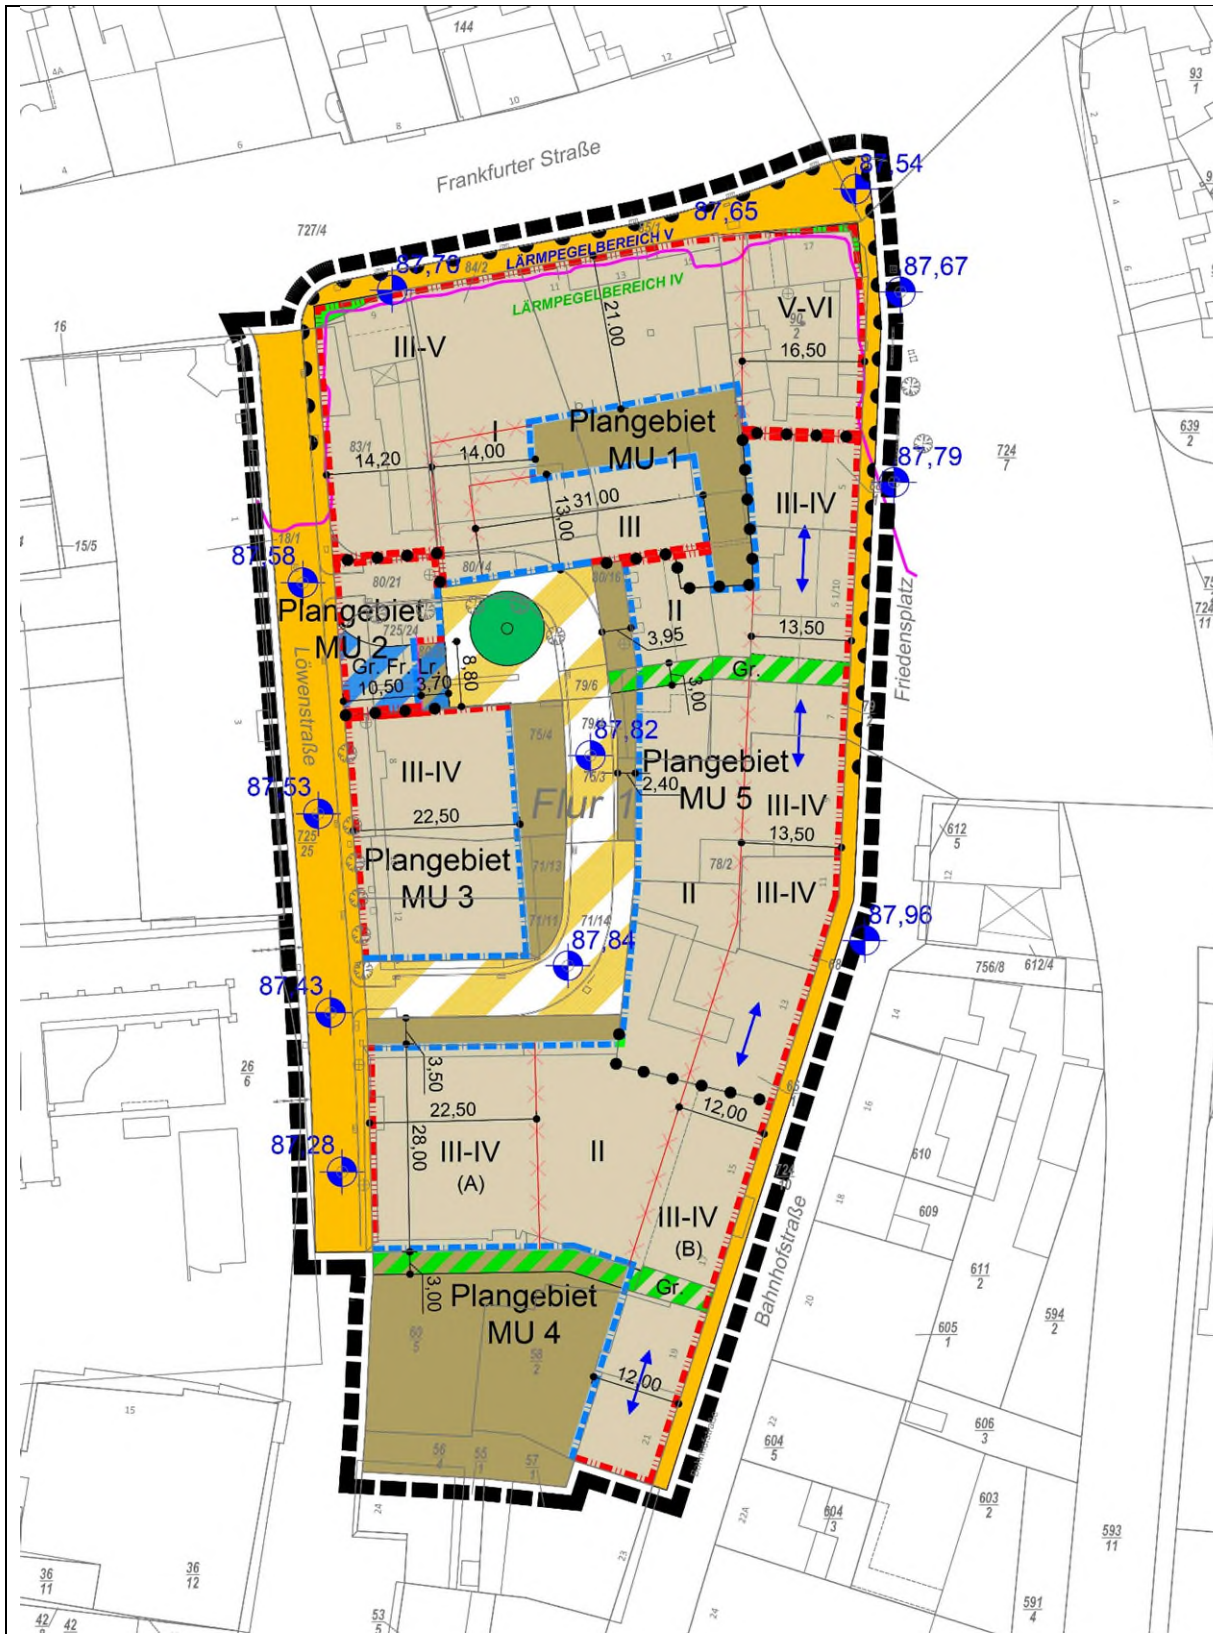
Bebauungsplan, Vorentwurf o.M., Planergruppe ASL, Frankfurt, Oktober 2019
